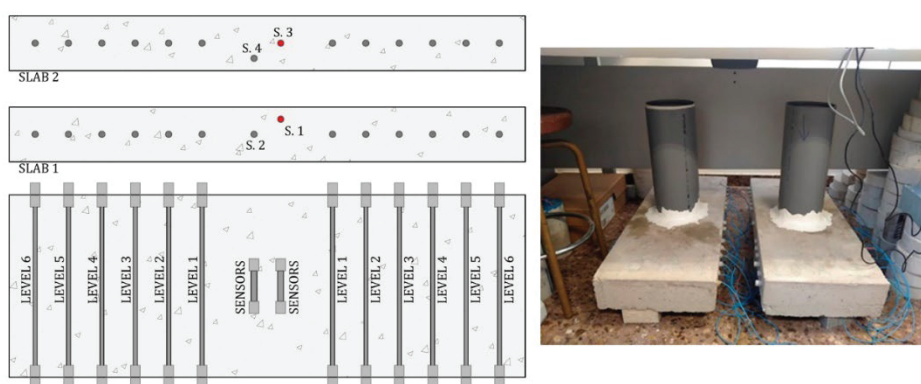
Montaje del depósito sobre la losa de hormigón armado.
